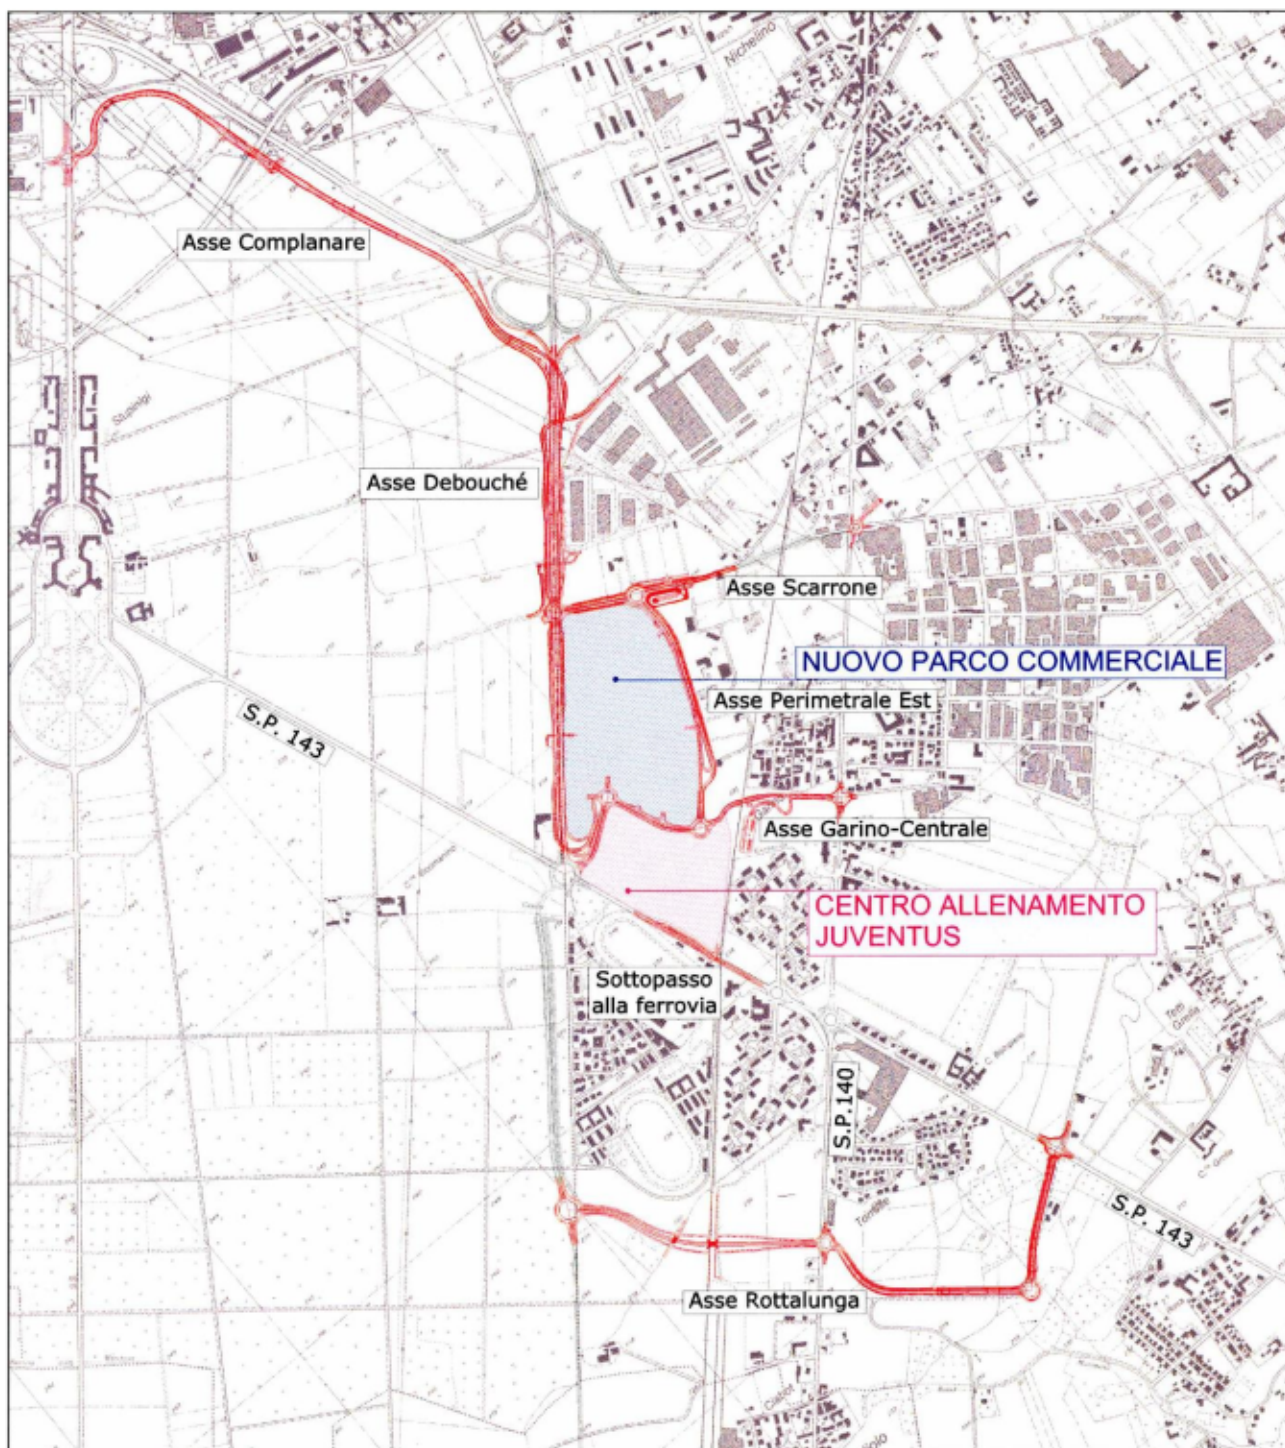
/1 Area del Parco Commerciale e viabilità connessa (progetto 2005)
